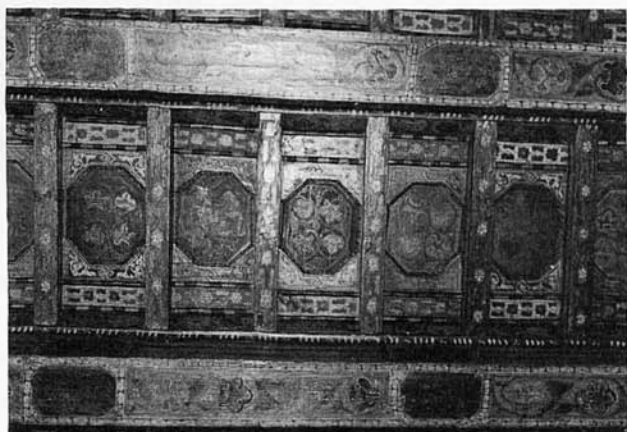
Detalle del trabajo de los casetones (Fundación B. March).
